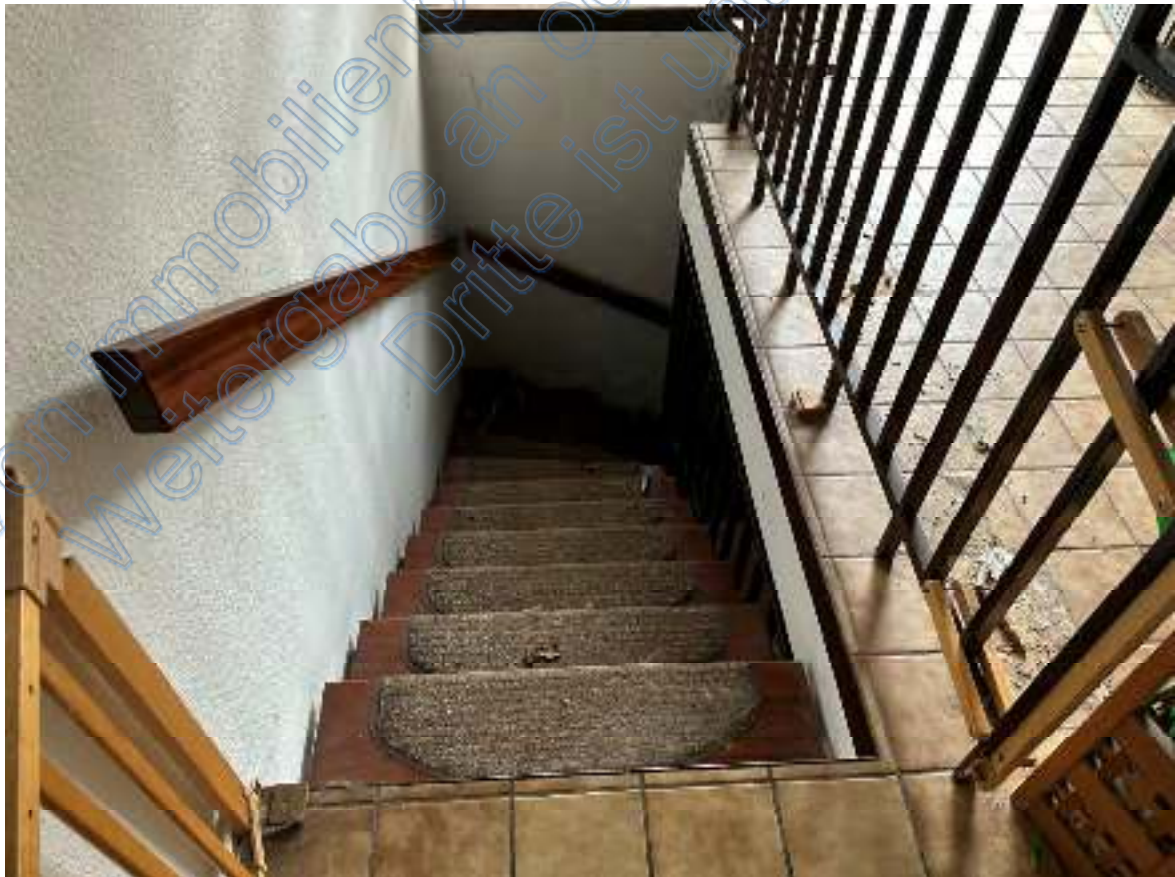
Ausschnitt – Treppe Richtung Flur im Kellergeschoss
